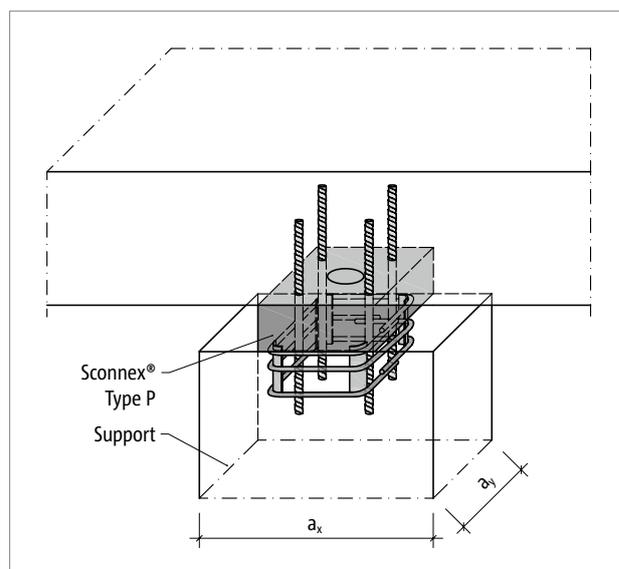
Schöck Sconnex® type P : raccordement pour un poteau rectangulaire ; montage centré - dimensions du poteau a_x et a_y , cf. page 126
